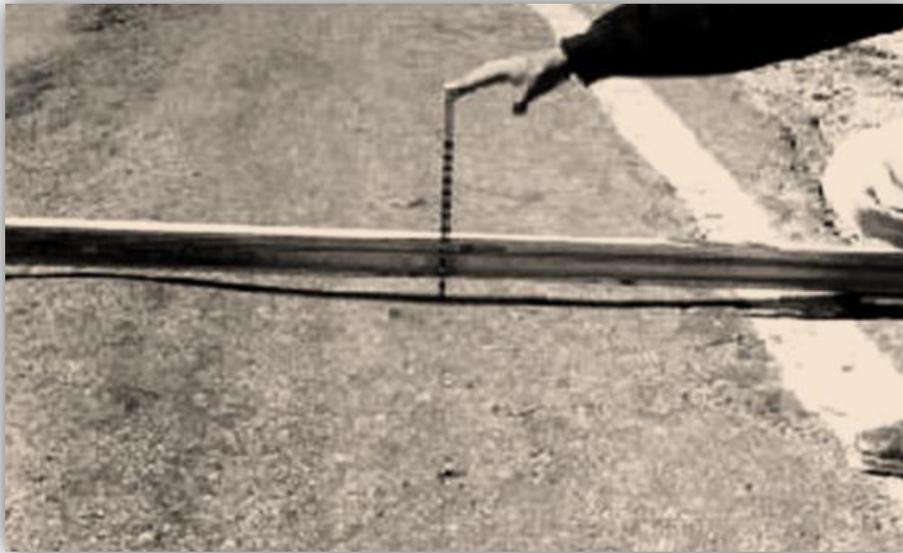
Falla estructural típica de un pavimento flexible (deformación de las roderas).
